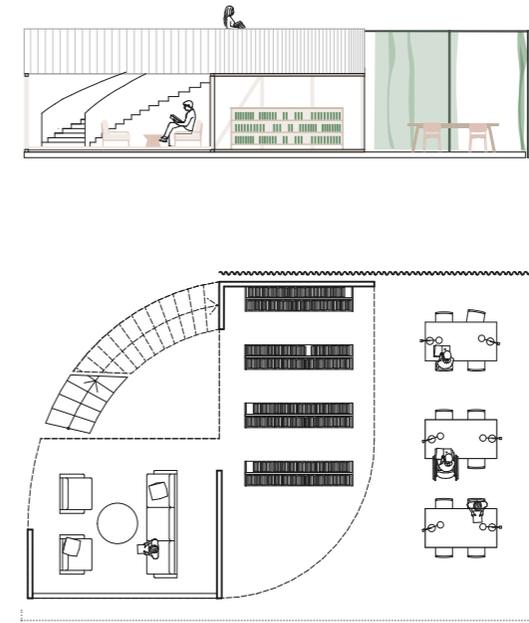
Bibliothek: Schnitt und Grundriss
